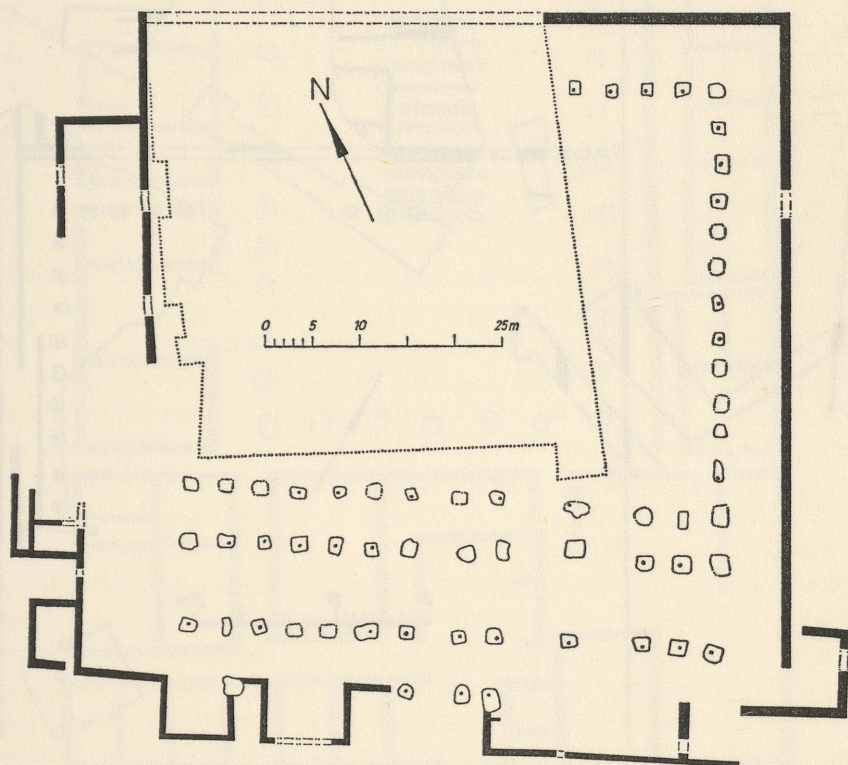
Grundriß eines Mittelgebäudes des Lagers C (?) in Neuß.
